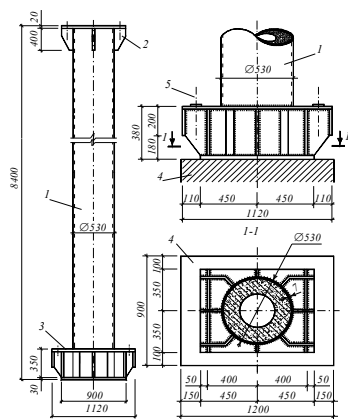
Одноветвевая трубобетонная колонна среднего ряда производственного здания: 1 - стержень колонны; 2 - оголовок; 3 - база; 4 - фундамент; 5 - ось анкерных болтов
